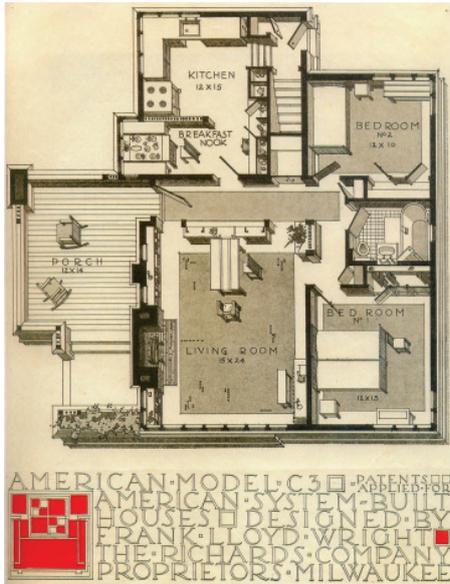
Planta do Modelo C-3, 1915-17, American System-Built Homes
